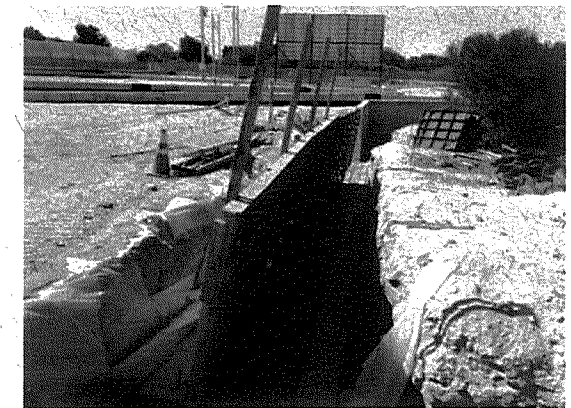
Pavimento de hormigón pigmentado de la ciclobanda se encuentra agrietado.
